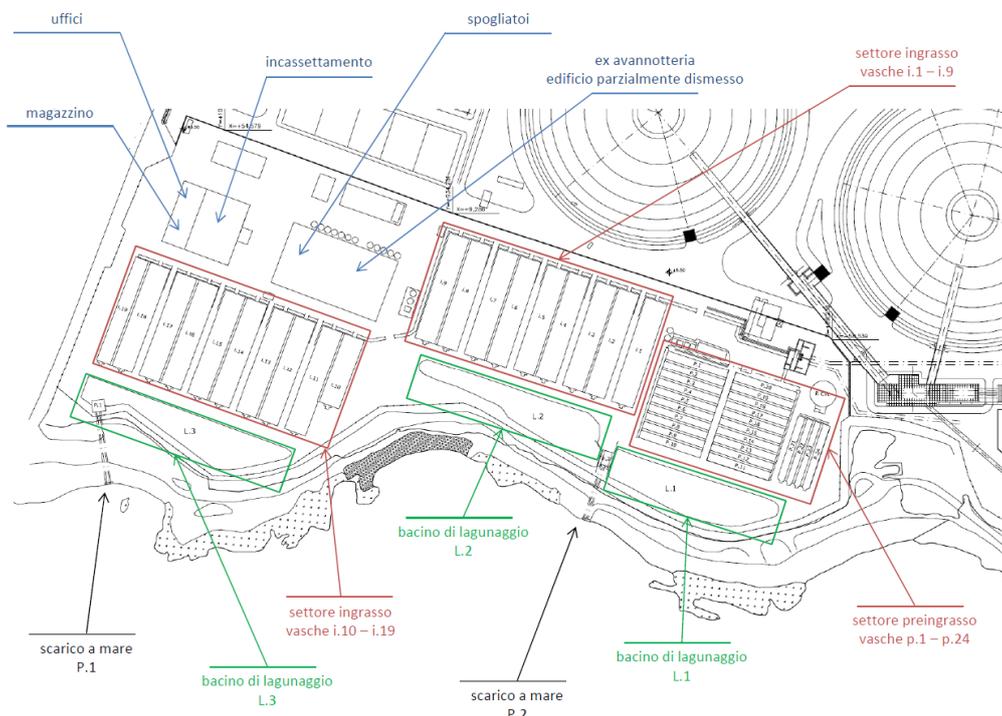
Planimetria e indicazione degli spazi dell’impianto a terra esistente
